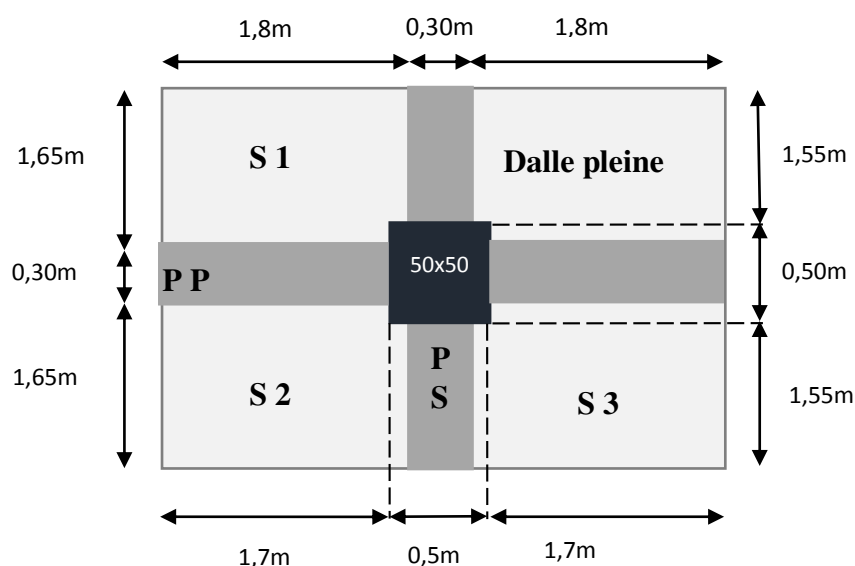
Dimension de la section revenant au poteau intermédiaire
